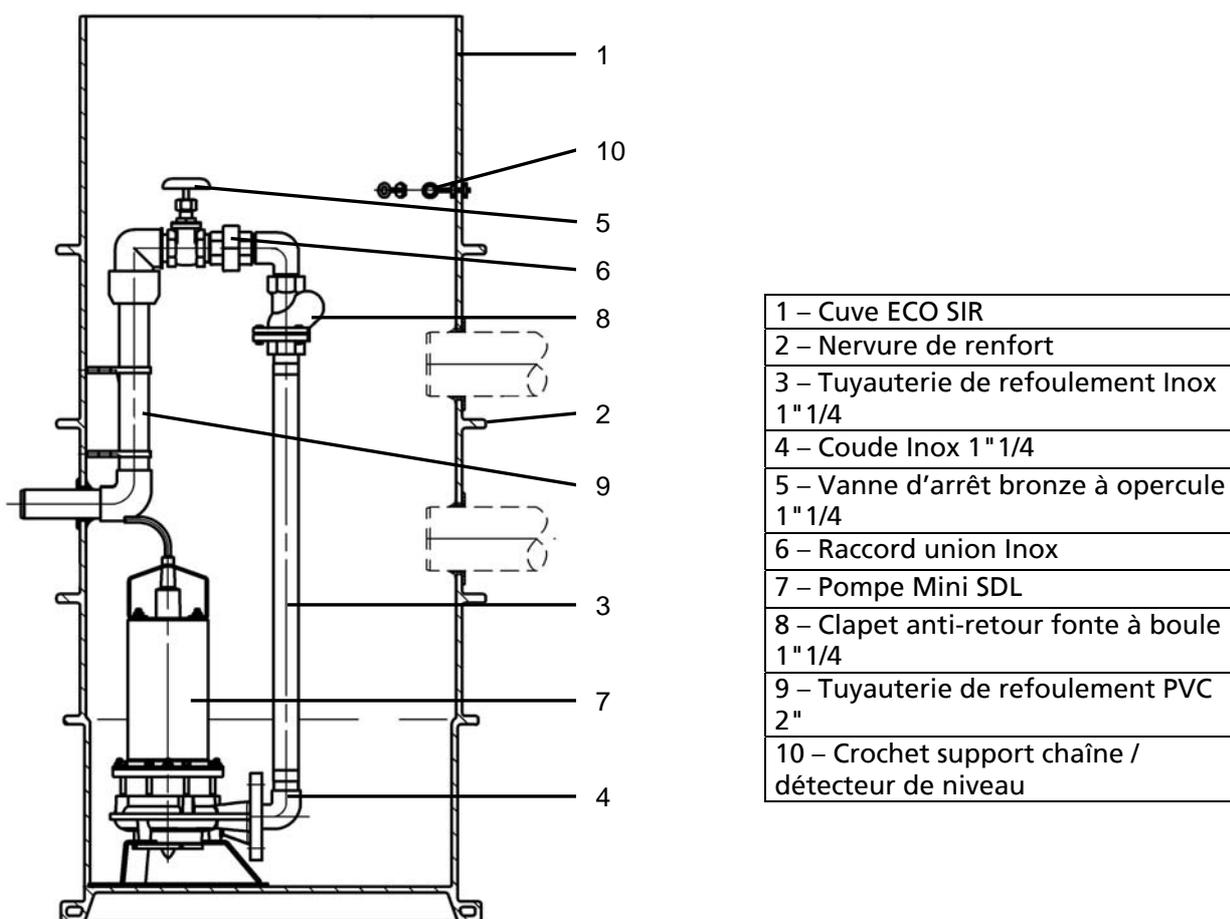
coupe en plan Inomenclature de la station ECO SIR
